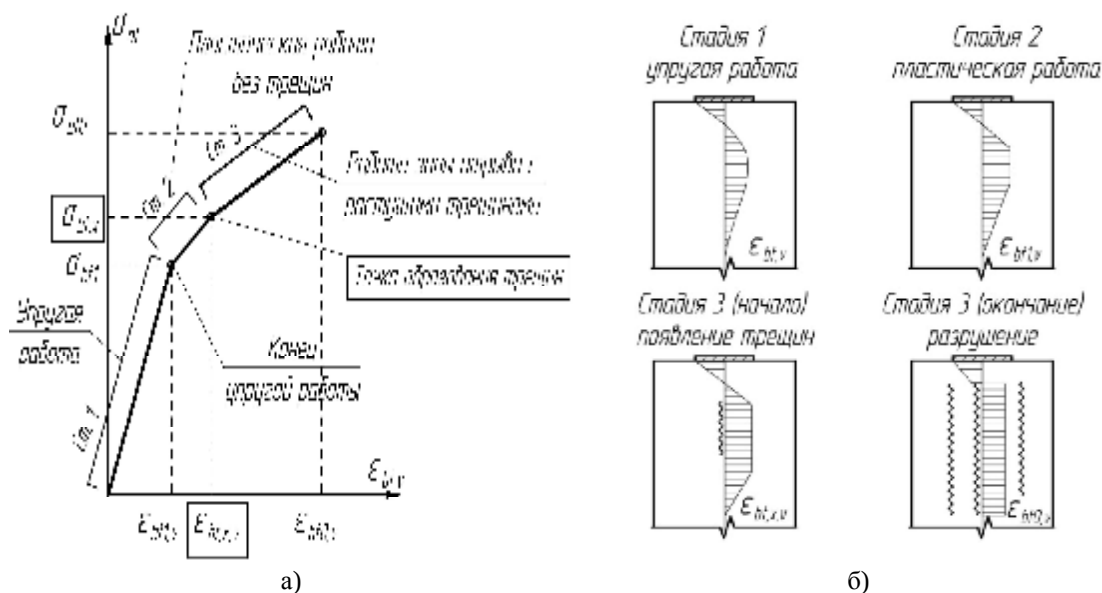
Схемы поперечного деформирования оголовка железобетонной колонны при сжатии:
